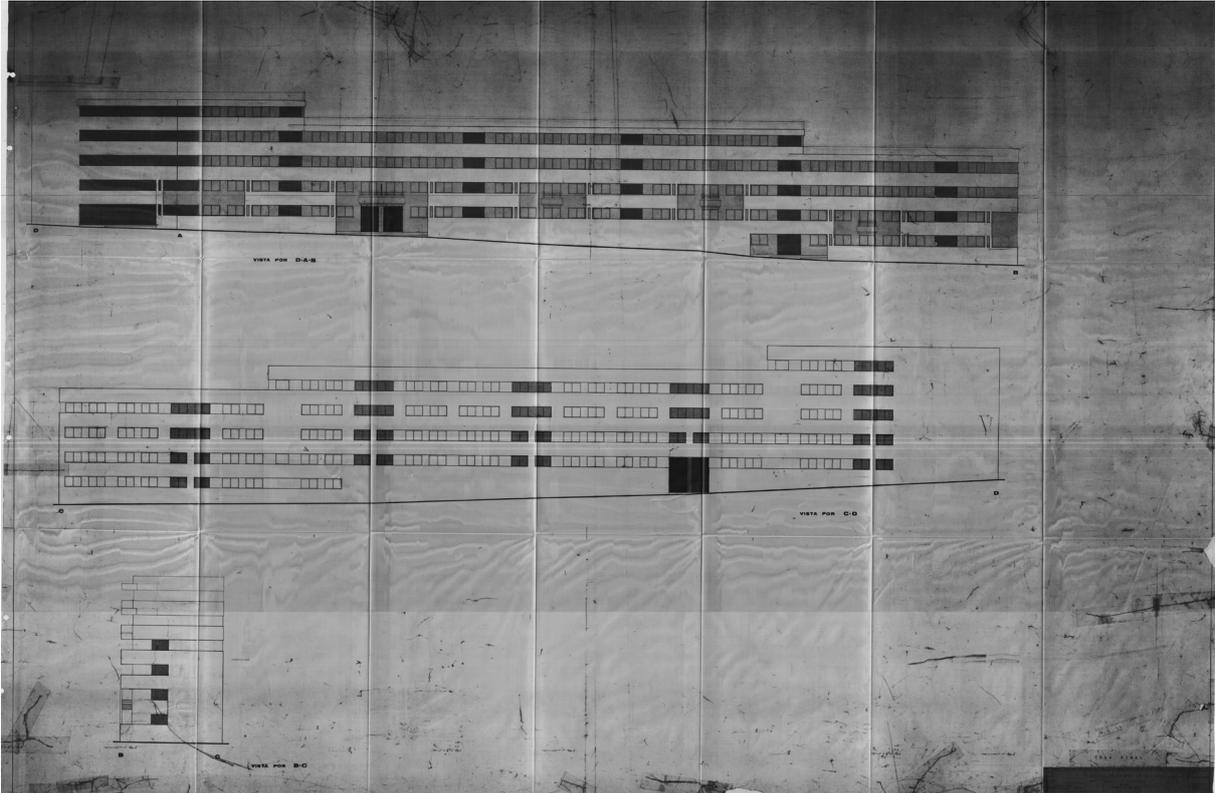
1ª fase do projeto de execução: telas finais, unidade 6, alçados
